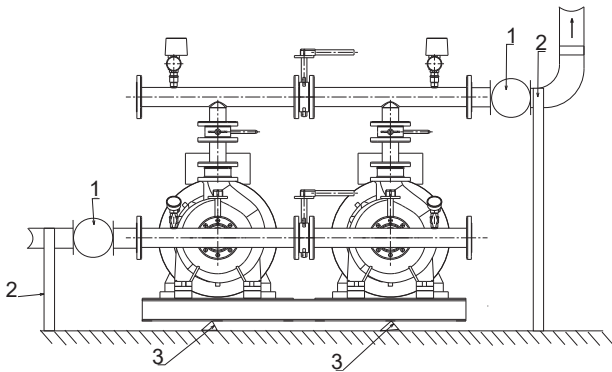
1 – Компенсаторы (упругие соединительные патрубки) для труб; 2 – Жесткие опоры для крепления труб; 3 – Виброизолирующие опоры
